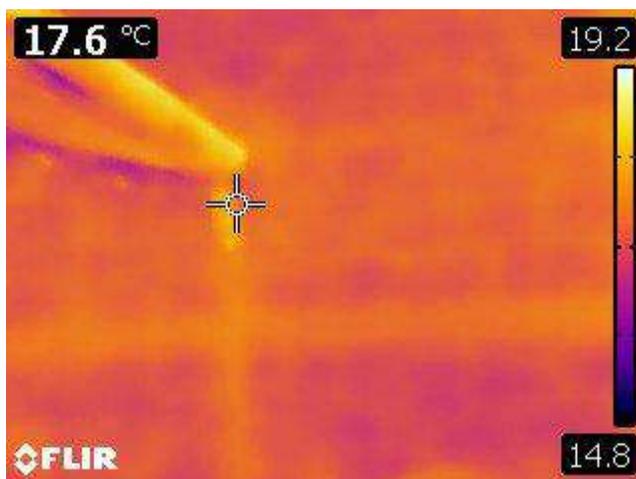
FLIR0232. Immagine termocamera del 24.04.2018. Tessitura muraria della Sala Teatro. Prospetto Nord
